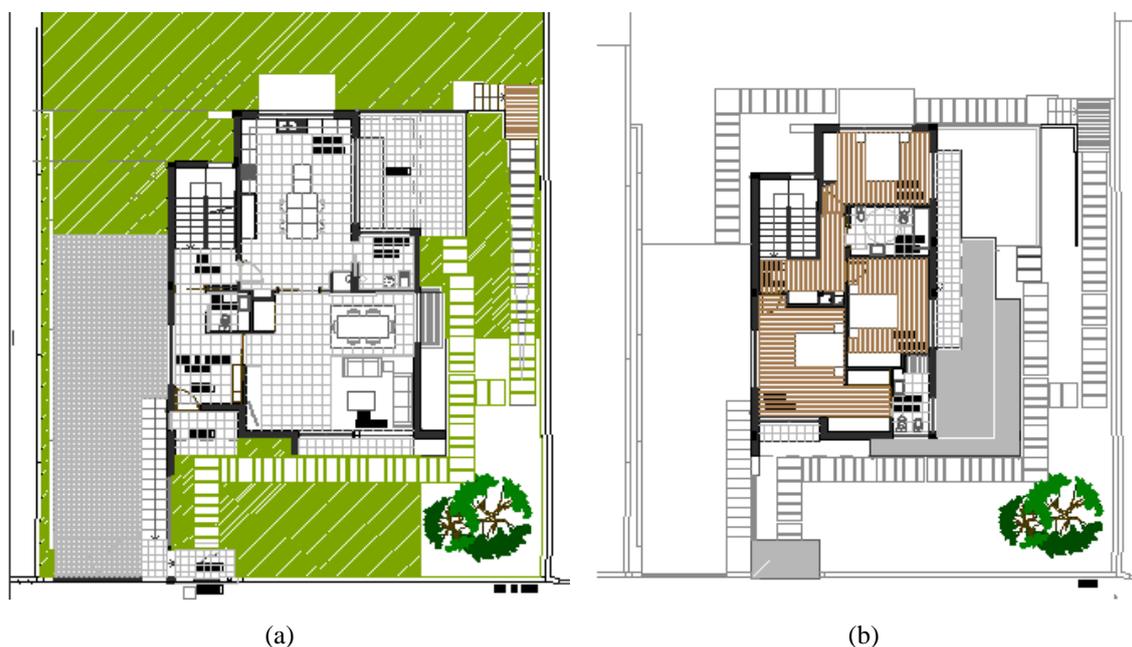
Planta de arquitetura. a) Planta do piso 0; b) Planta do piso 1
